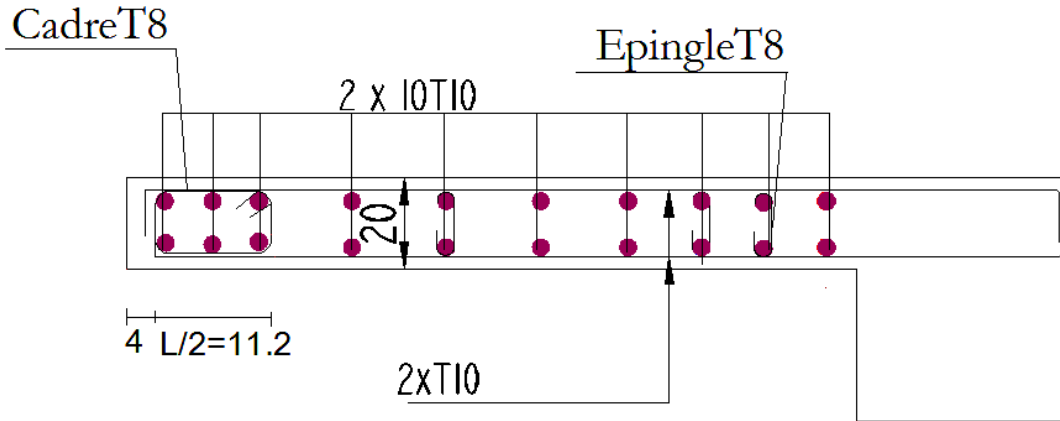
Exemple de ferrailage du voile V_{x1} (e=20cm)
